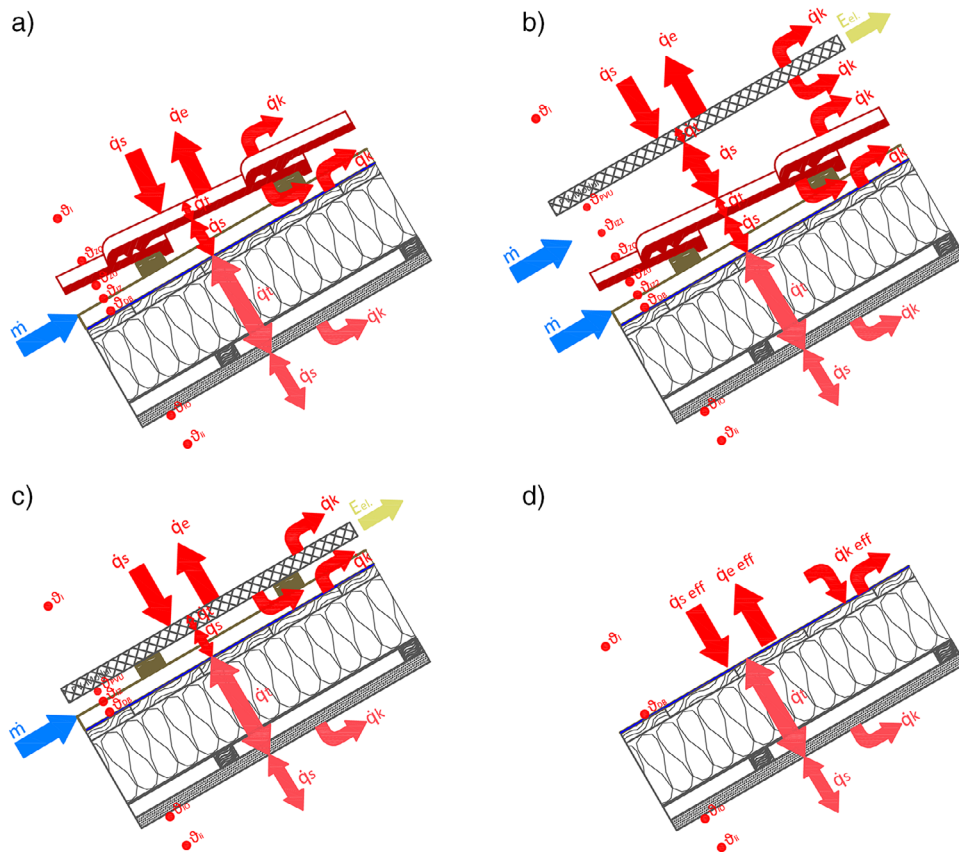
Darstellung der Wärmeübertragungsvorgänge einer Steildachkonstruktion, a) mit klassischer Eindeckung aus Dachsteinen oder Dachziegeln, b) mit Aufdach-Solaranlage (hier beispielhaft PV-Module), c) mit Indach-Solaranlage, die die Eindeckung ersetzt (hier beispielhaft PV-Module), d) ohne Eindeckung und PV, mit effektiven Strahlungs- und Konvektions-Parametern (Quelle: Kölsch/Fraunhofer IBP)
